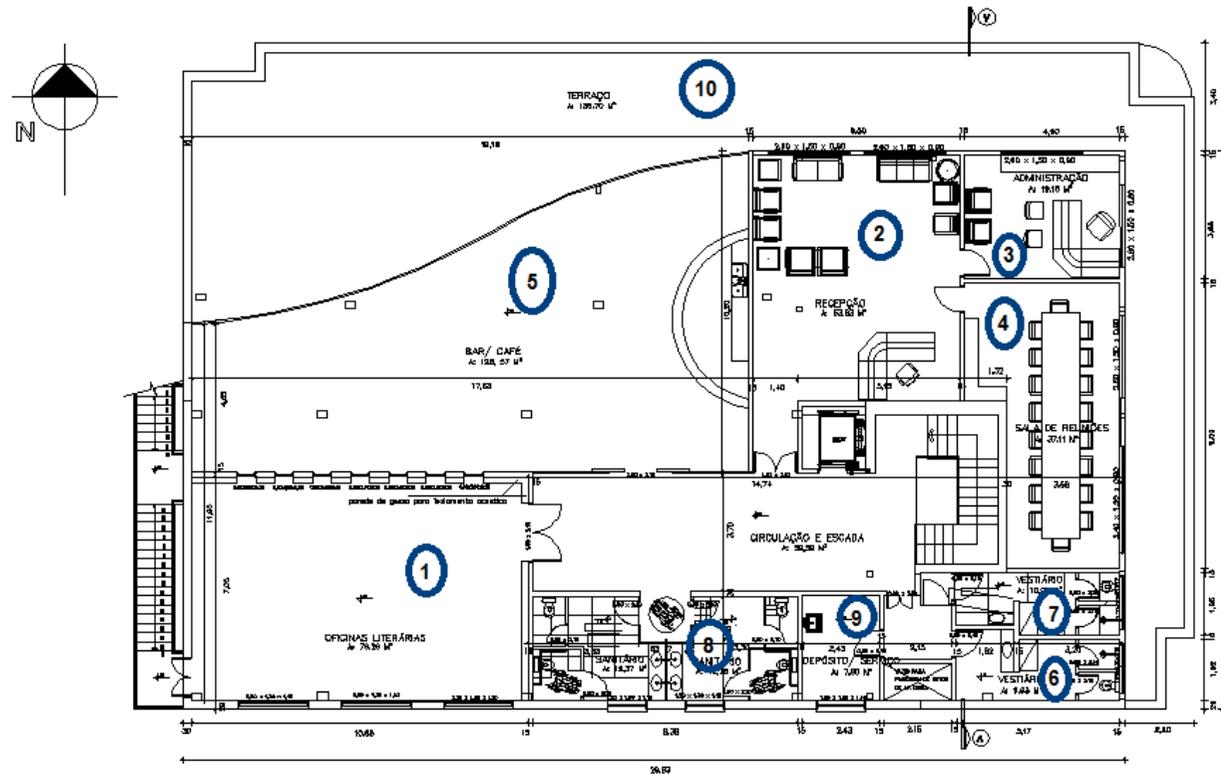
Planta Baixa Reforma Pavimento Intermediário.
